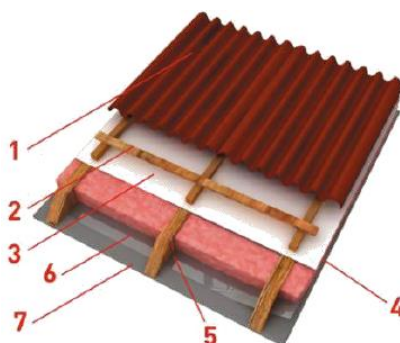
Структура скатной кровли: 1 – черепица или другой кровельный материал; 2 – шаговая (поперечная) обрешетка; 3 – ветро- и влагозащитная мембрана; 4 – слой утеплителя; 5 – стропила; 6 – слой пароизоляции; 7 – слой внутренней отделки
